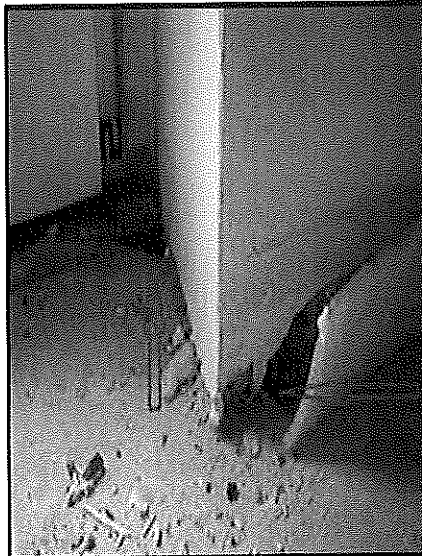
Flux d'air au niveau des liaisons périphériques (parois, plancher) dans la chambre
